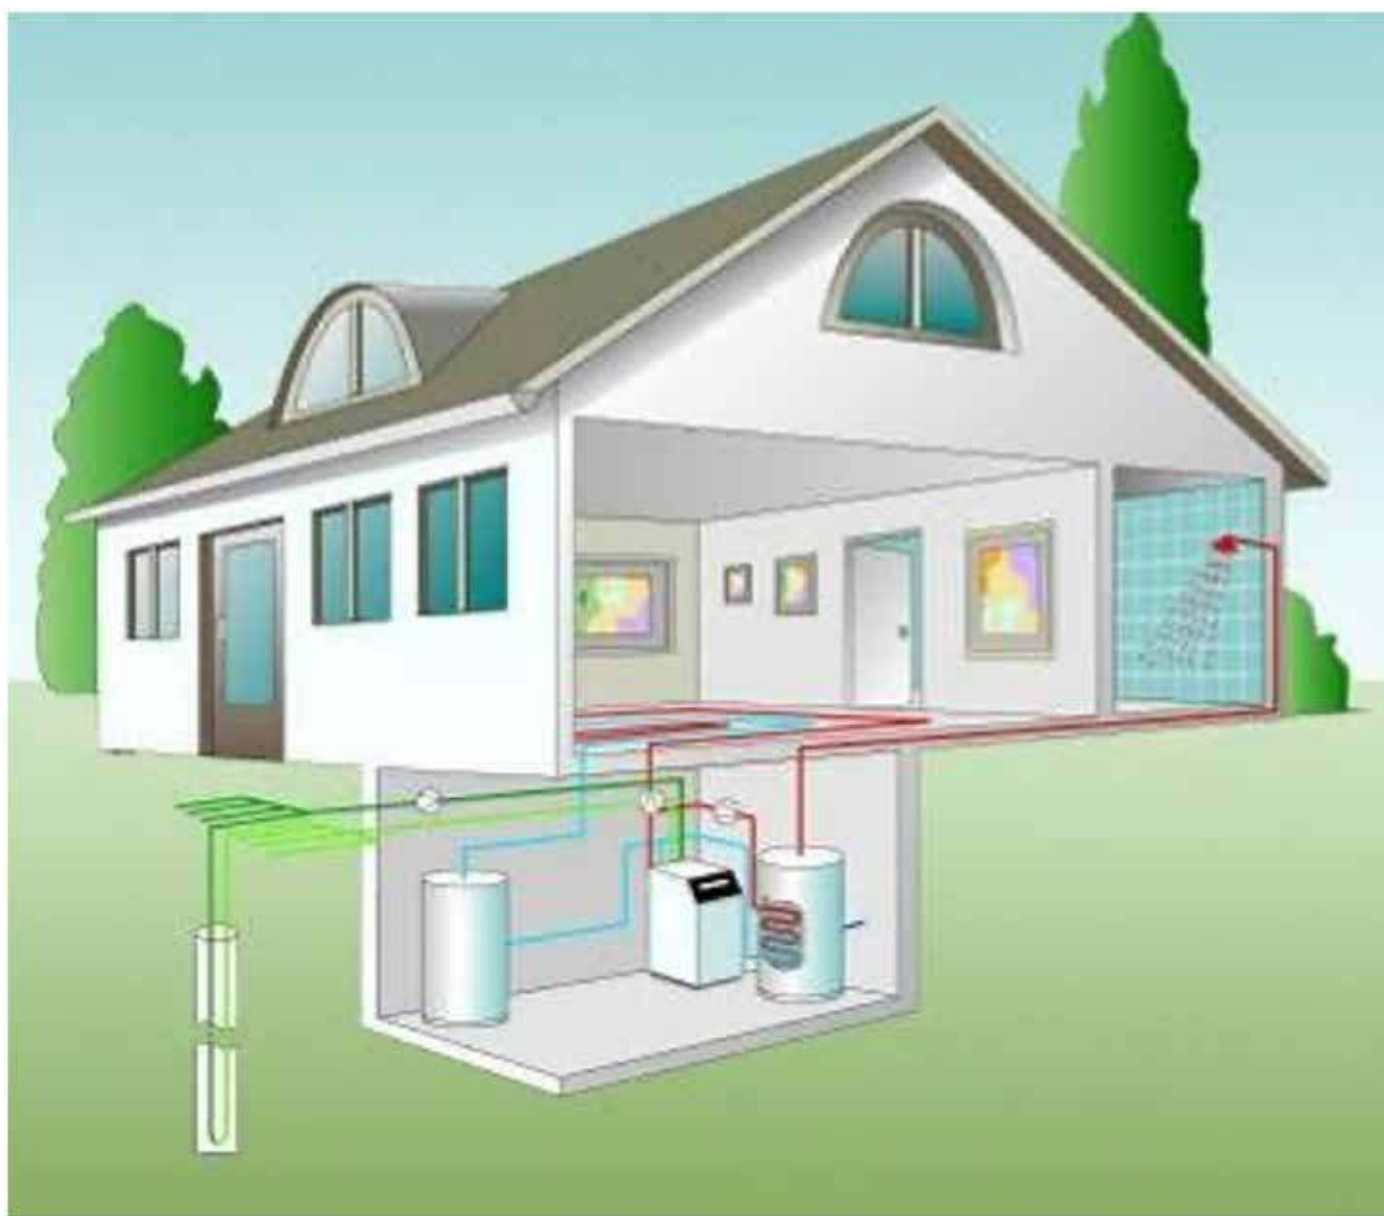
Esquema de instalación geotérmica con sonda vertical Fuente: www.bemco.be
